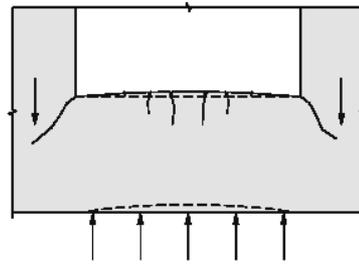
Fundações contínuas solicitadas por carregamentos não uniformes: sob as aberturas surgem fissuras de flexão
